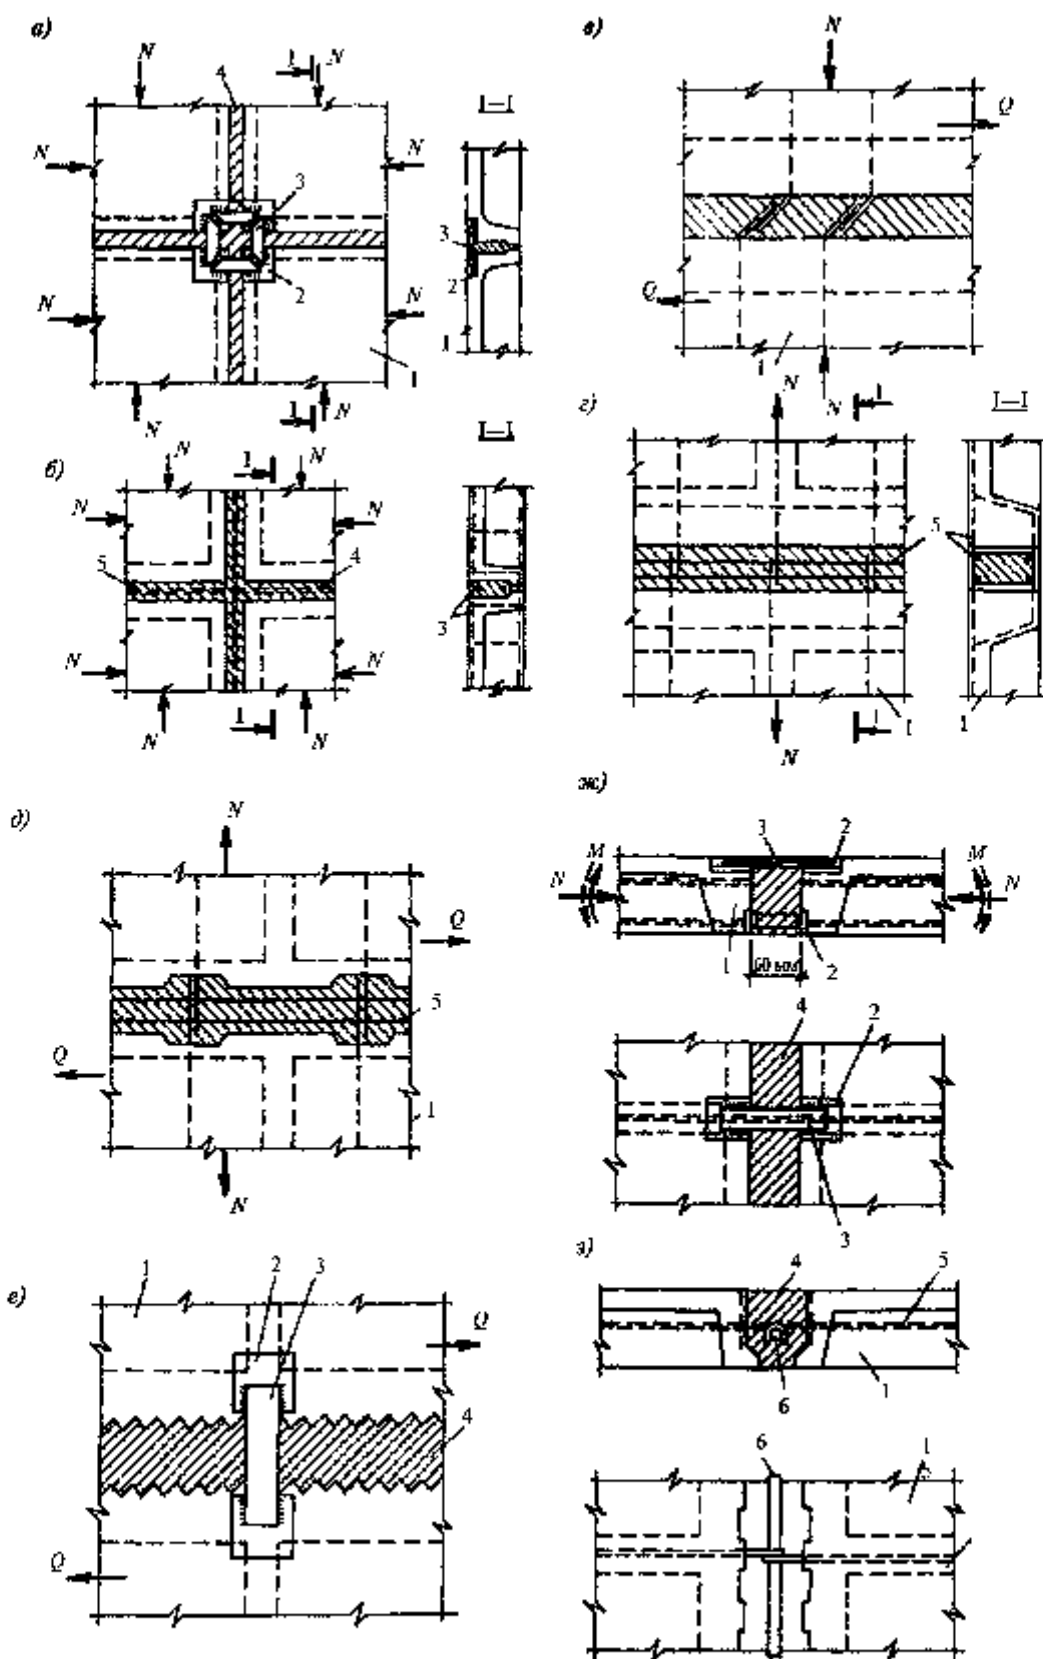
Примеры членения сборных пространственных покрытий и перекрытий
